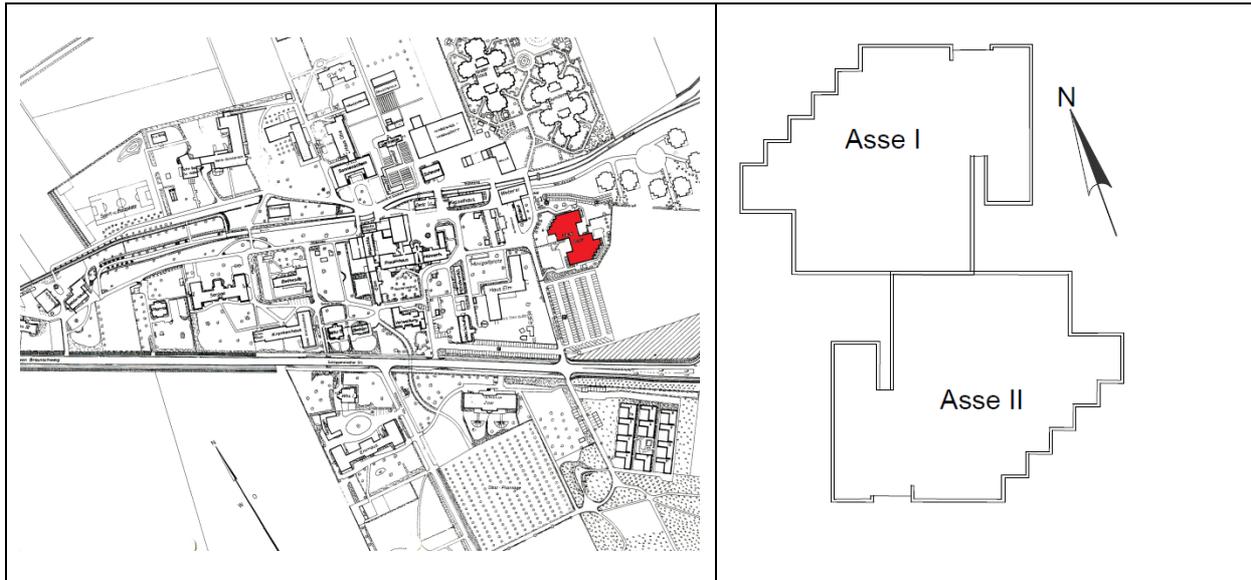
Lage und Grundriss GebäudeASSE [3][6]
